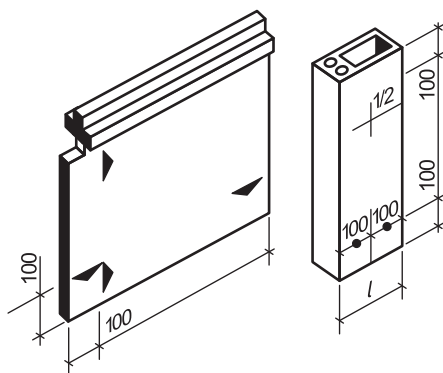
Места съемки элементов стеновых конструкций зданий
